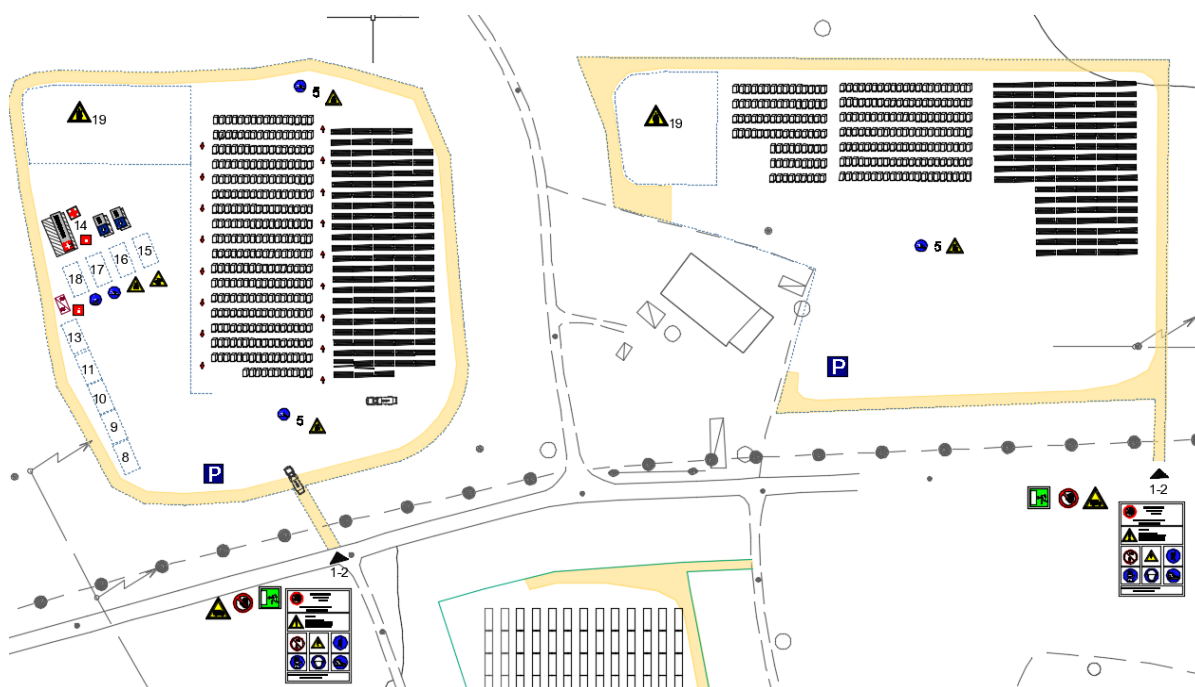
Area di cantiere principale “Campo Morino”, ricezione, stoccaggio e movimentazione materiali
